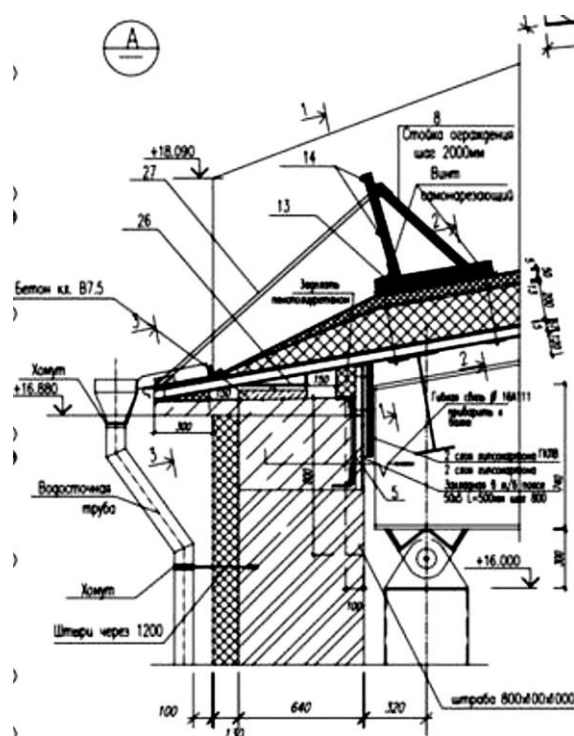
Узел примыкания мягкой кровли с элементами снегозадерживания
